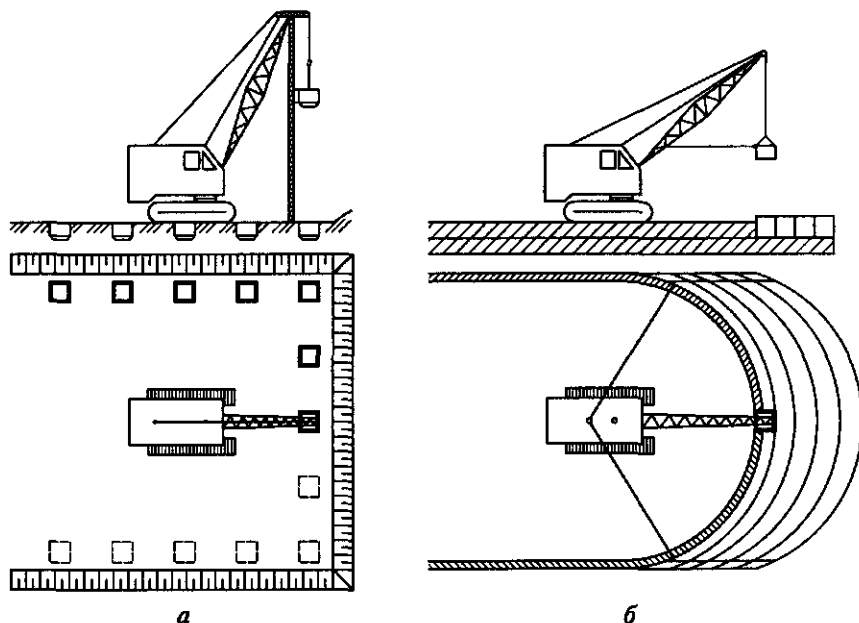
Подготовка оснований под здание на просадочных грунтах:
